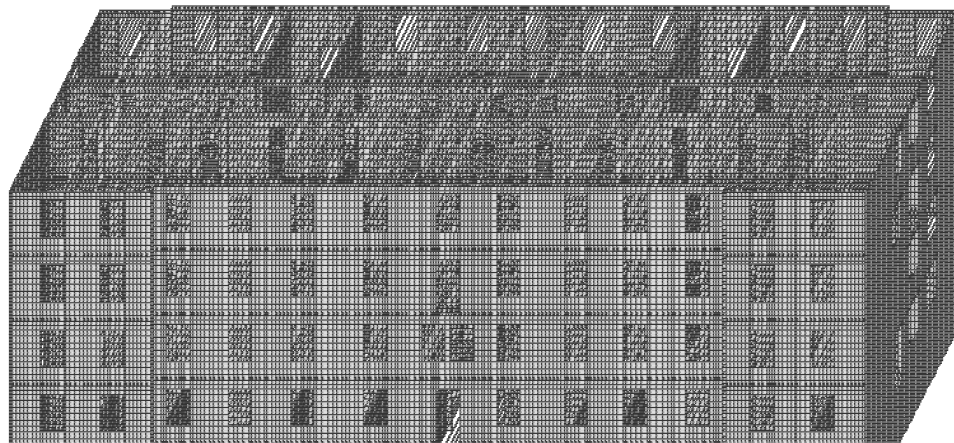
Розрахункова схема моделі будівлі з урахуванням надбудови додаткового поверху
